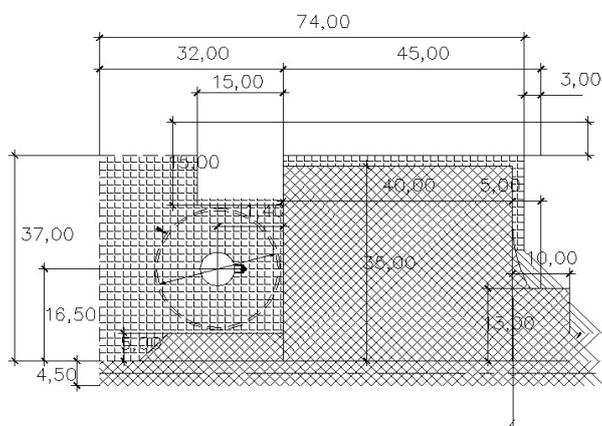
Схема размещения крановой площадки для установки гусеничного крана «Liebherr LR 11000».
